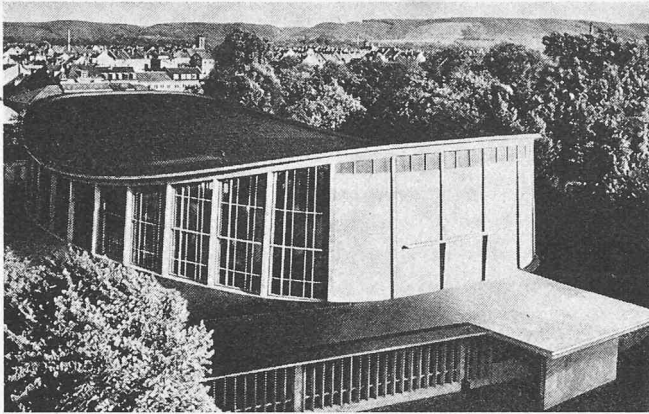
Schwarzwaldhalle Karlsruhe, in sich verspanntes Hängedach über elliptischem Grundriss, mit den Hauptachsenlängen 48 m und 73 m. Erstes Spannbetonhängedach Europas
